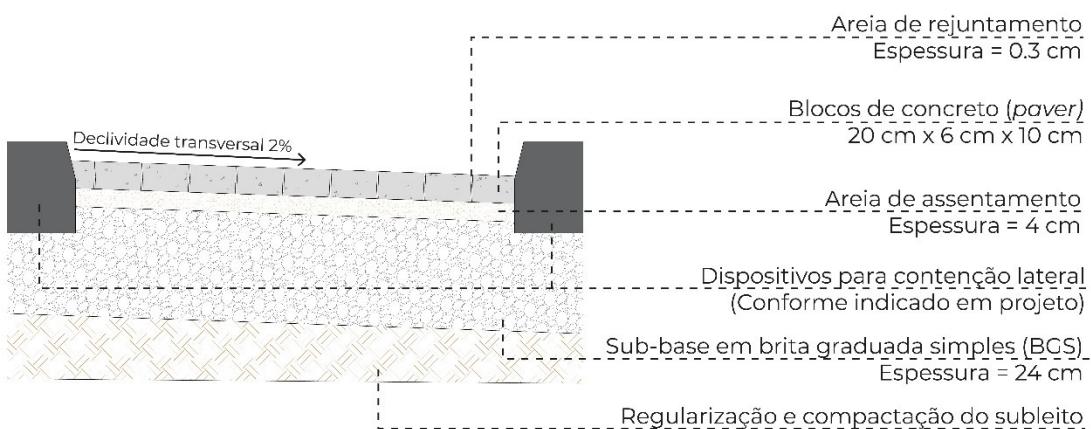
Seção transversal-tipo do pavimento do estacionamento
